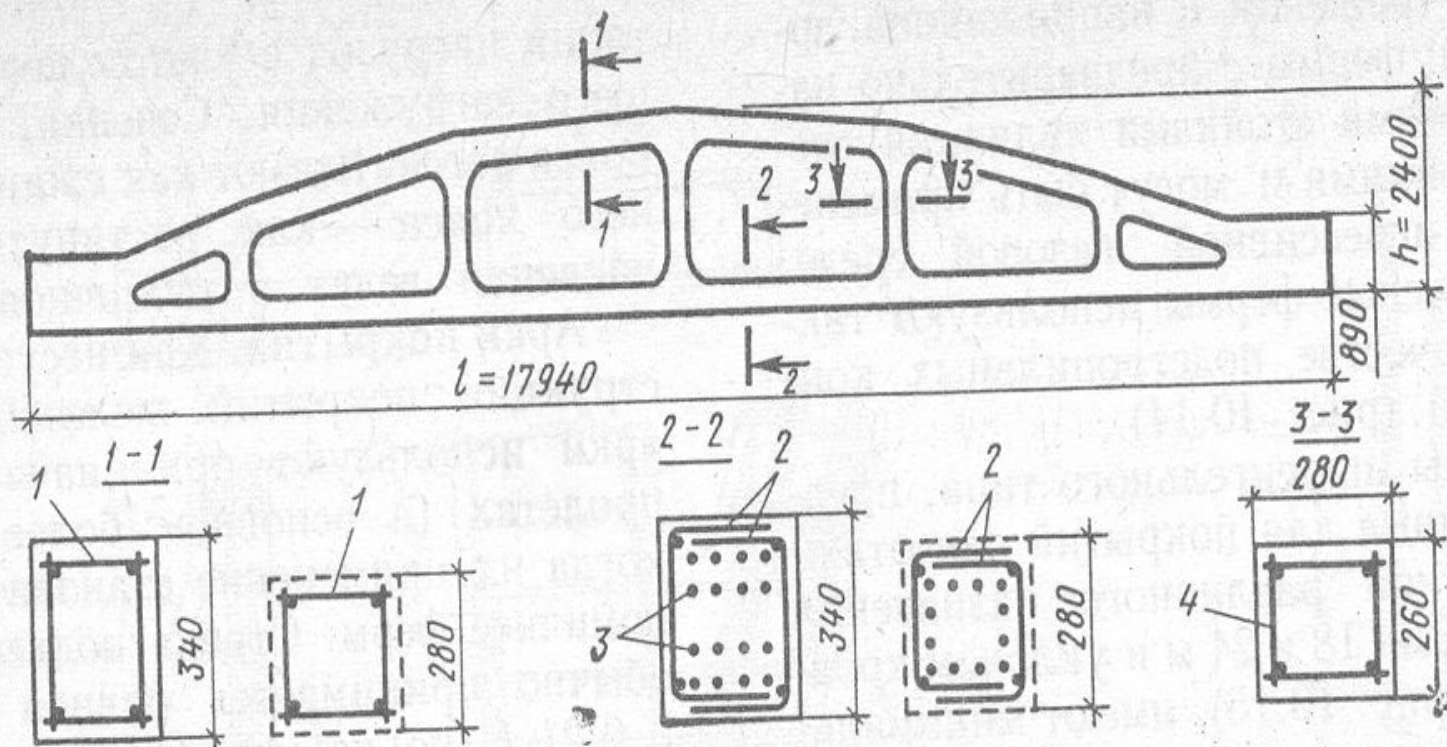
Конструкции безраскосных ферм пролетом 18 м при шаге колонн 12 м (пунктиром показаны контуры ферм для шага 6 м):
